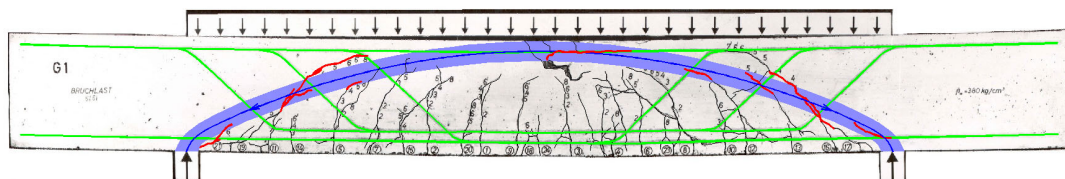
Balken G 1 mit überlagerter Druckparabel und zugehörigen Rissen
